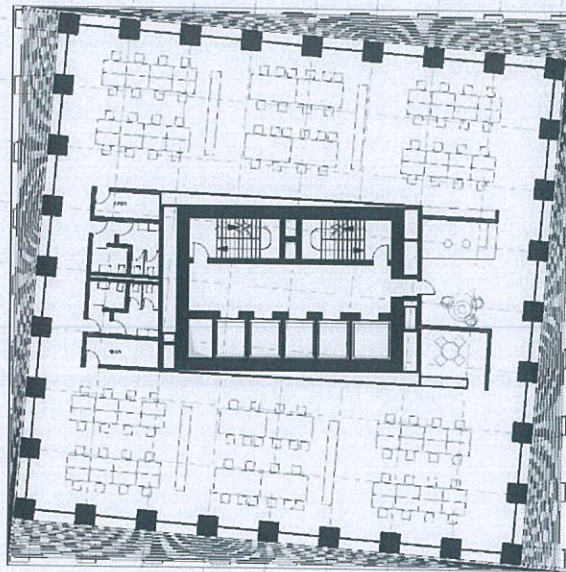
Planimetri e katit +9, në kuotën +37.8 (Skema e funksionit zyra, kati 5-14)
